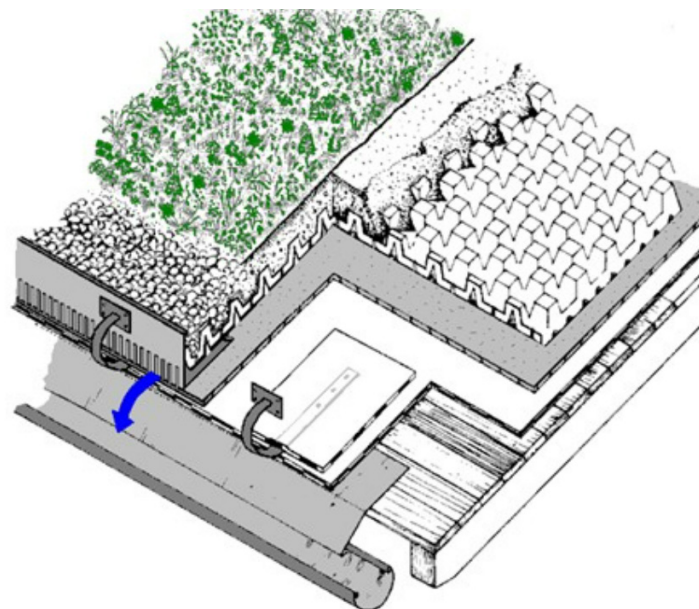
Resolución del alero con perfil metálico perforado con puntos de anclaje.
